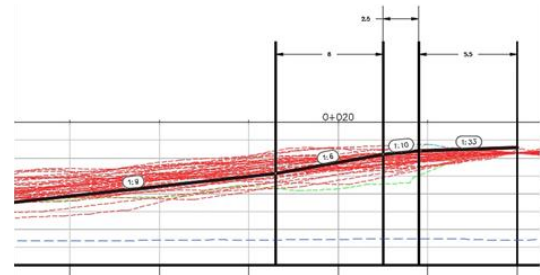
Comportamiento de la sección longitudinal del conjunto de descargas seleccionado
